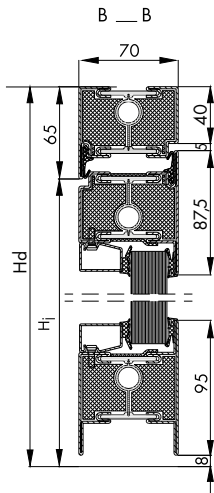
Coupe verticale d'une porte coupe-feu à un battant EI 60 dans le système Jansen Janisol C4.
